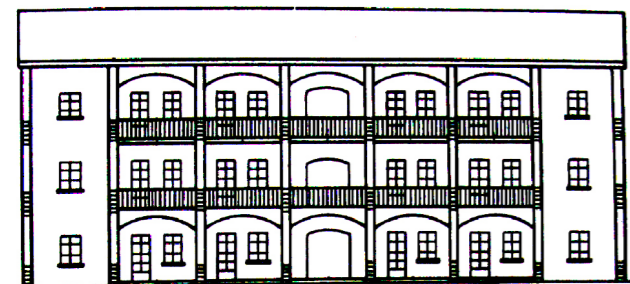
prospetto tipo di cascina pluriaziendale dell'altopiano asciutto
